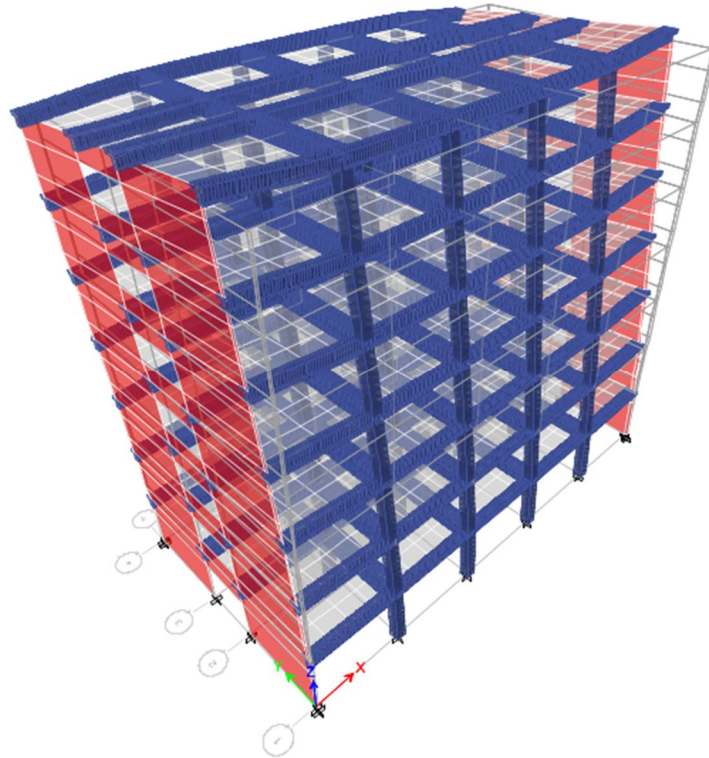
Baę kirişli (boşluklu) perdeli bina kat kalıp plan görünüşü
